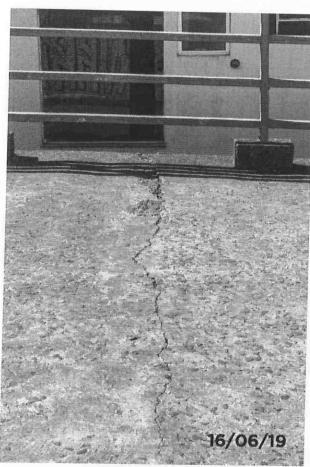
Detalhe da rachadura e trincas no Tabuleiro.
